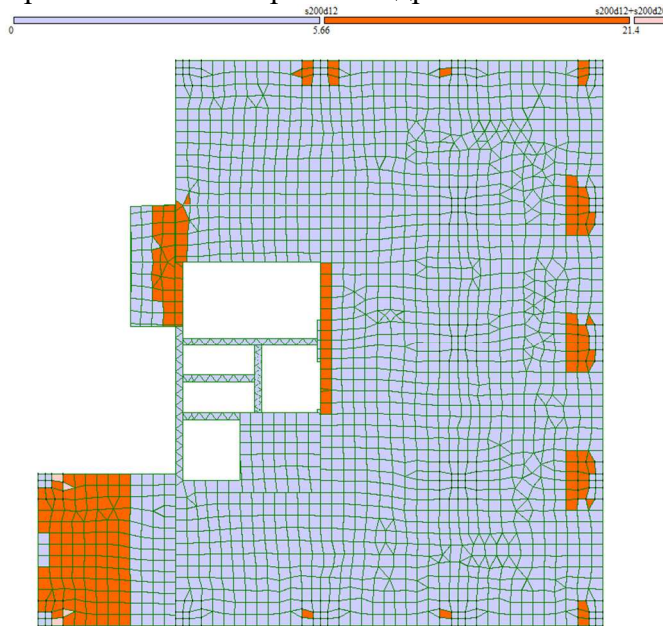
Верхнее армирование перекрытия по оси х
